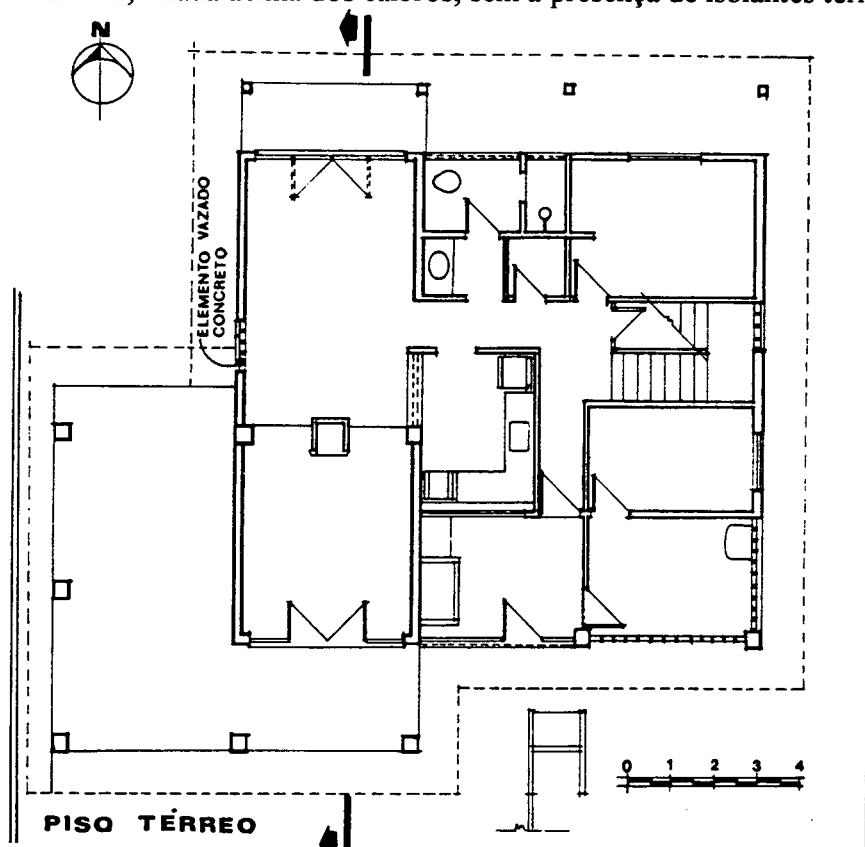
Casa dos Ingleses, planta baixa piso térreo .
